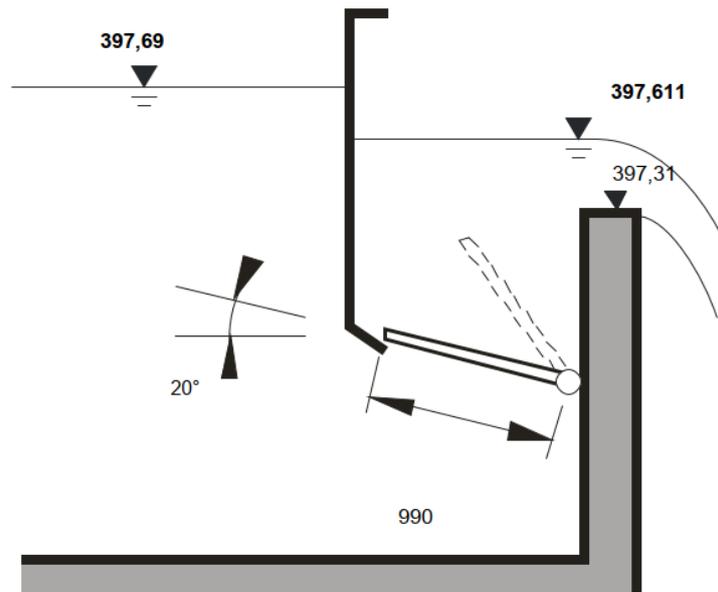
sich einstellende Überfallhöhe bedingt durch Pendelrechen
